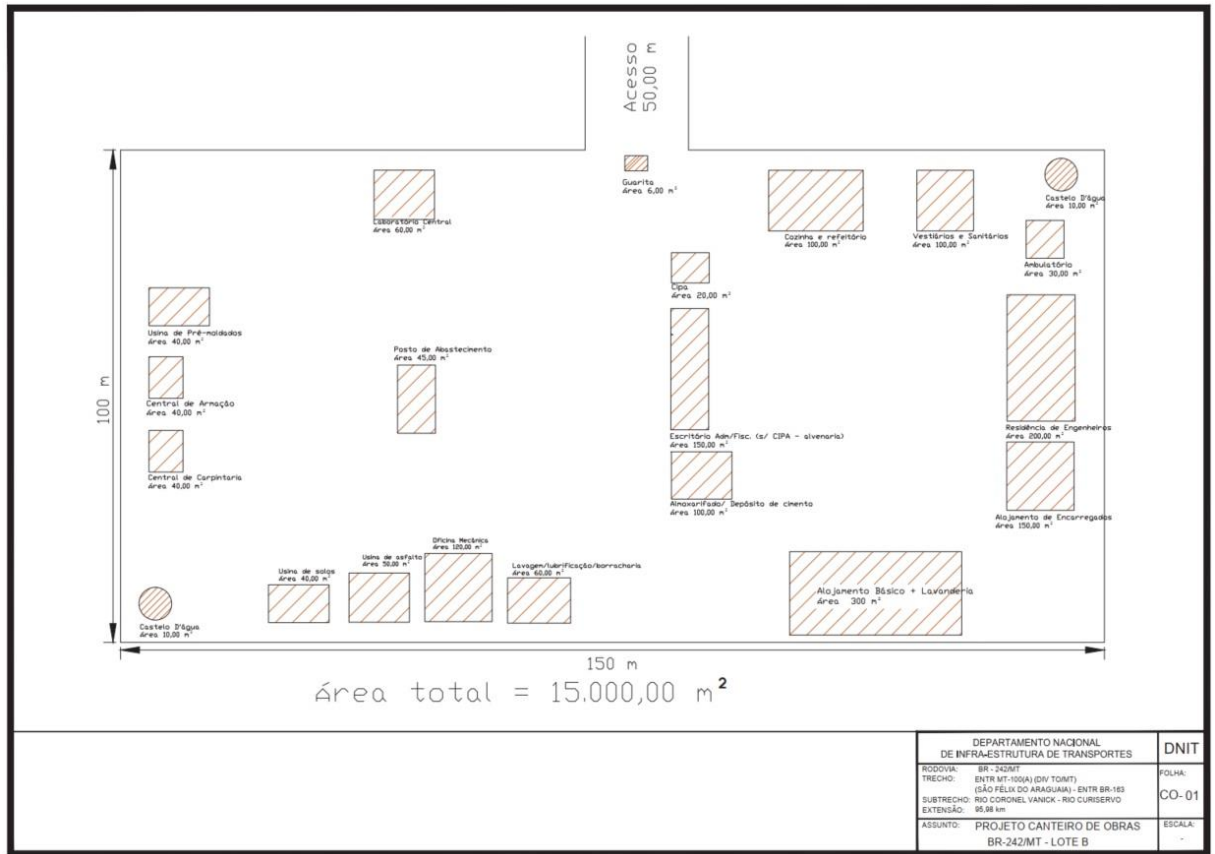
Estrutura prevista para o canteiro de obras no Segmento B da BR-242/MT.
